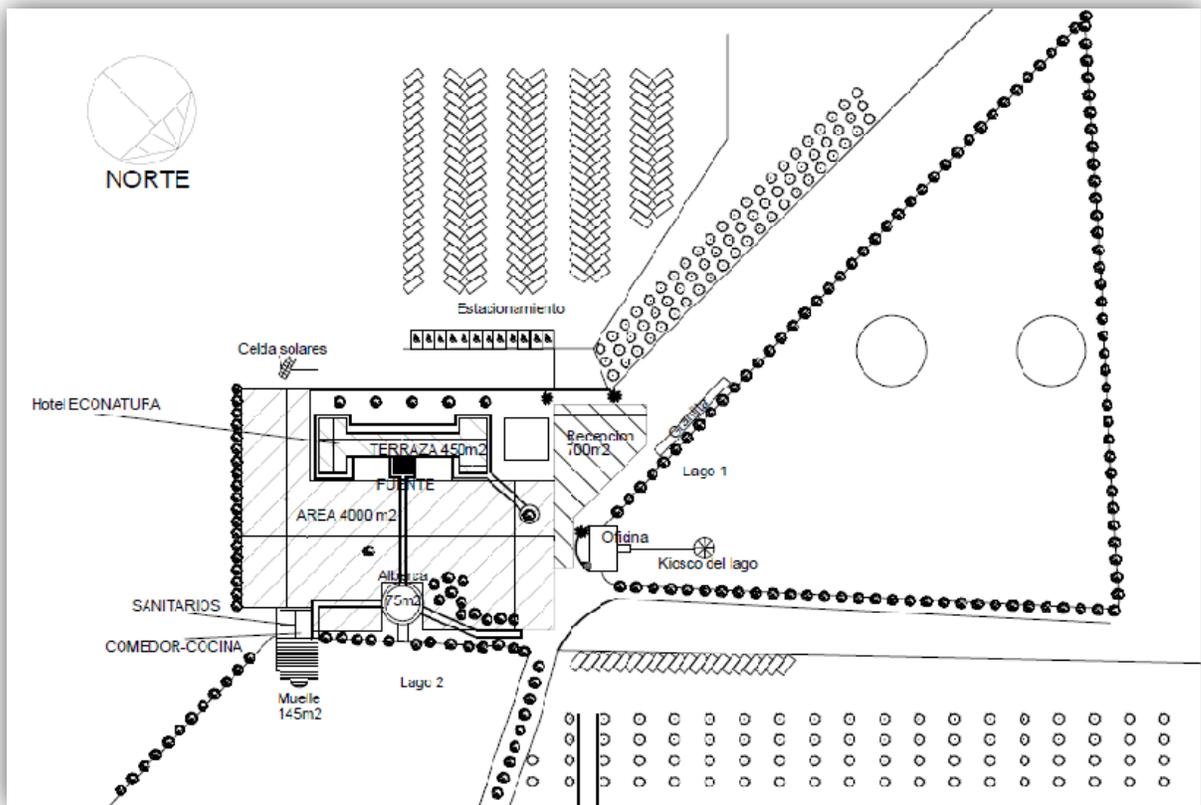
Planta arquitectónica del Hotel Boutique Econatura. Fuente: Adolfo Rubio
